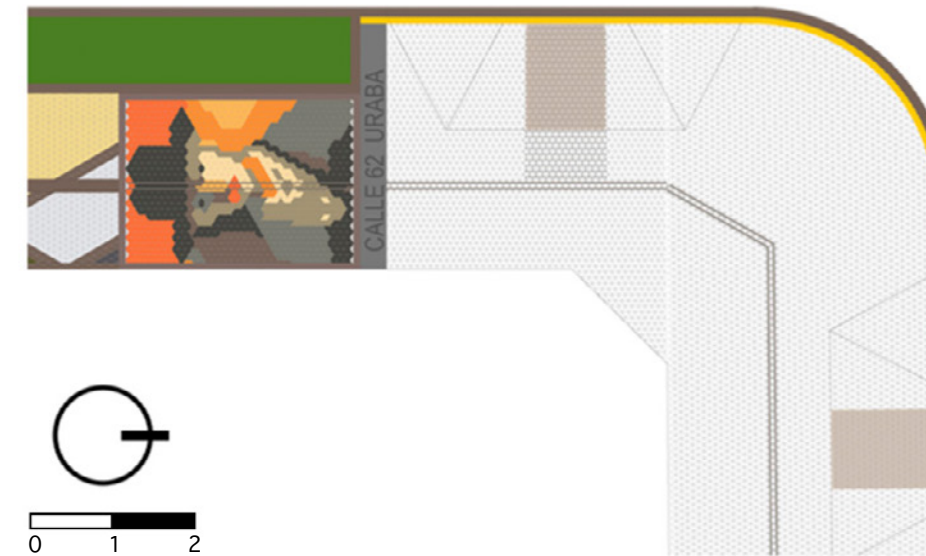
Planta de segmento de tramo 2. Elaborado por: Equipo de diseño A+U.
